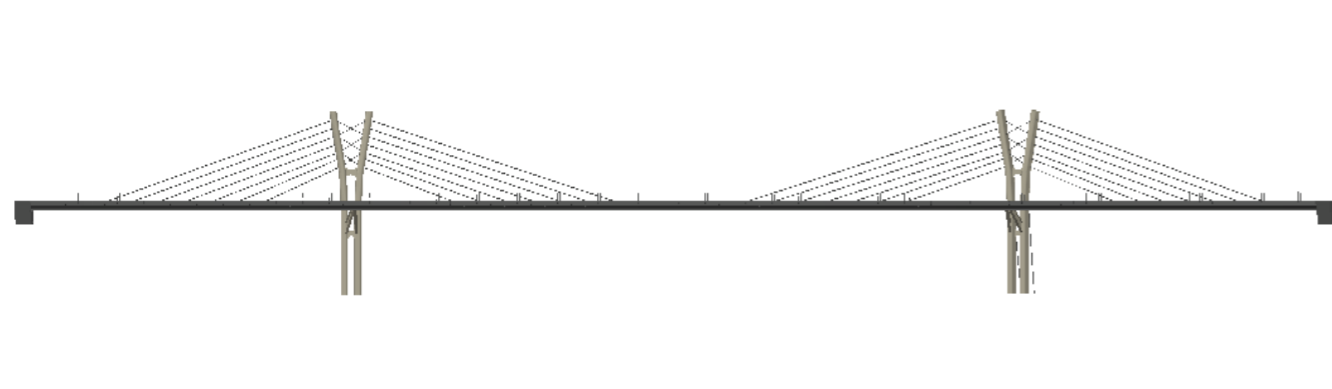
Vista en alzado de la pasarela. Fuente: Elaboración propia.
